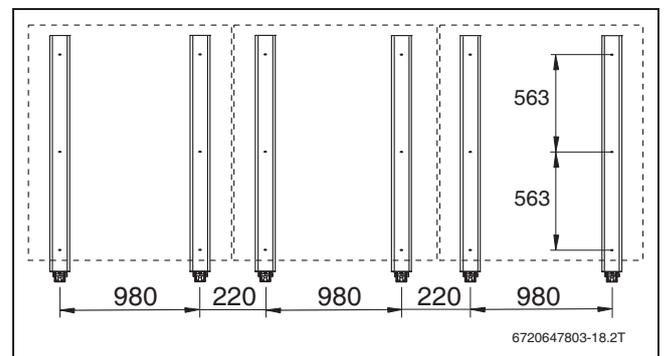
Distanze dei supporti dei collettori in caso di carichi elevati per tre collettori verticali Logasol SKN4.0-s (misure in mm)
